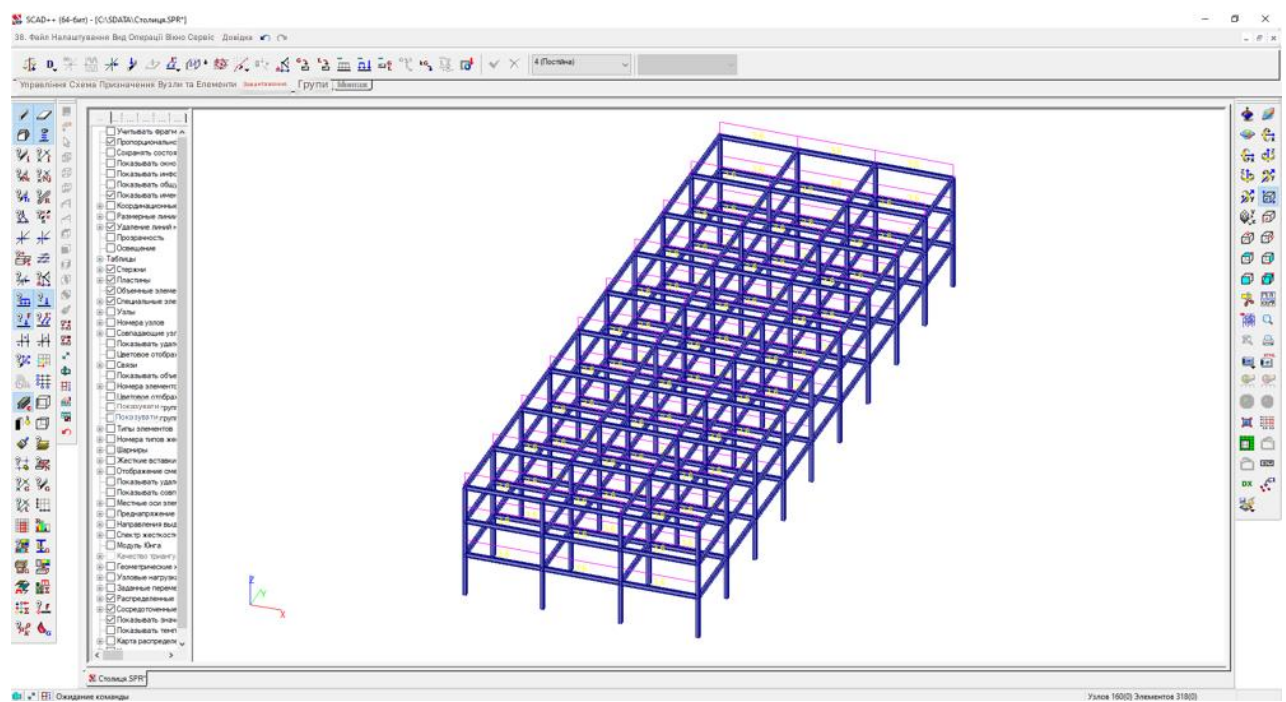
Просторова розрахункова схема будівлі з прикладеними постійними навантаженнями
